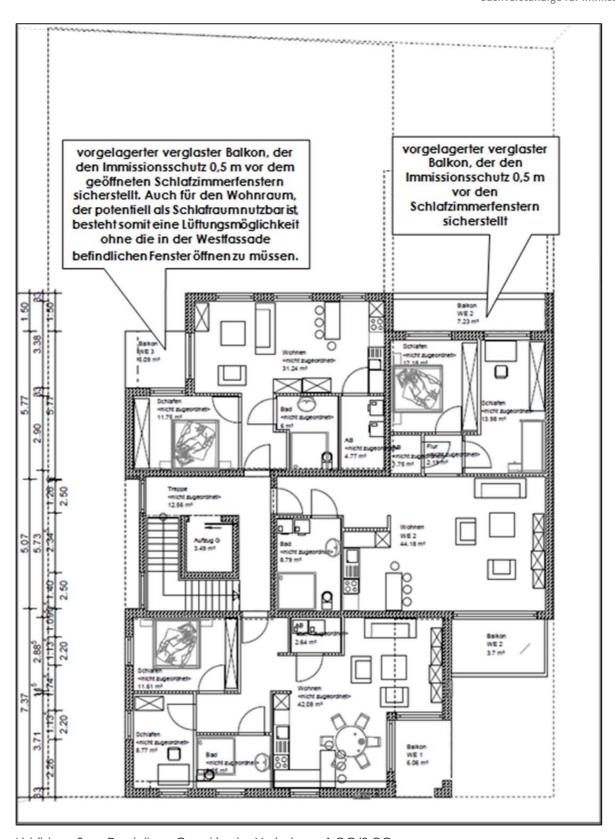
Darstellung Grundriss des Vorhabens, 1 OG/2.OG
